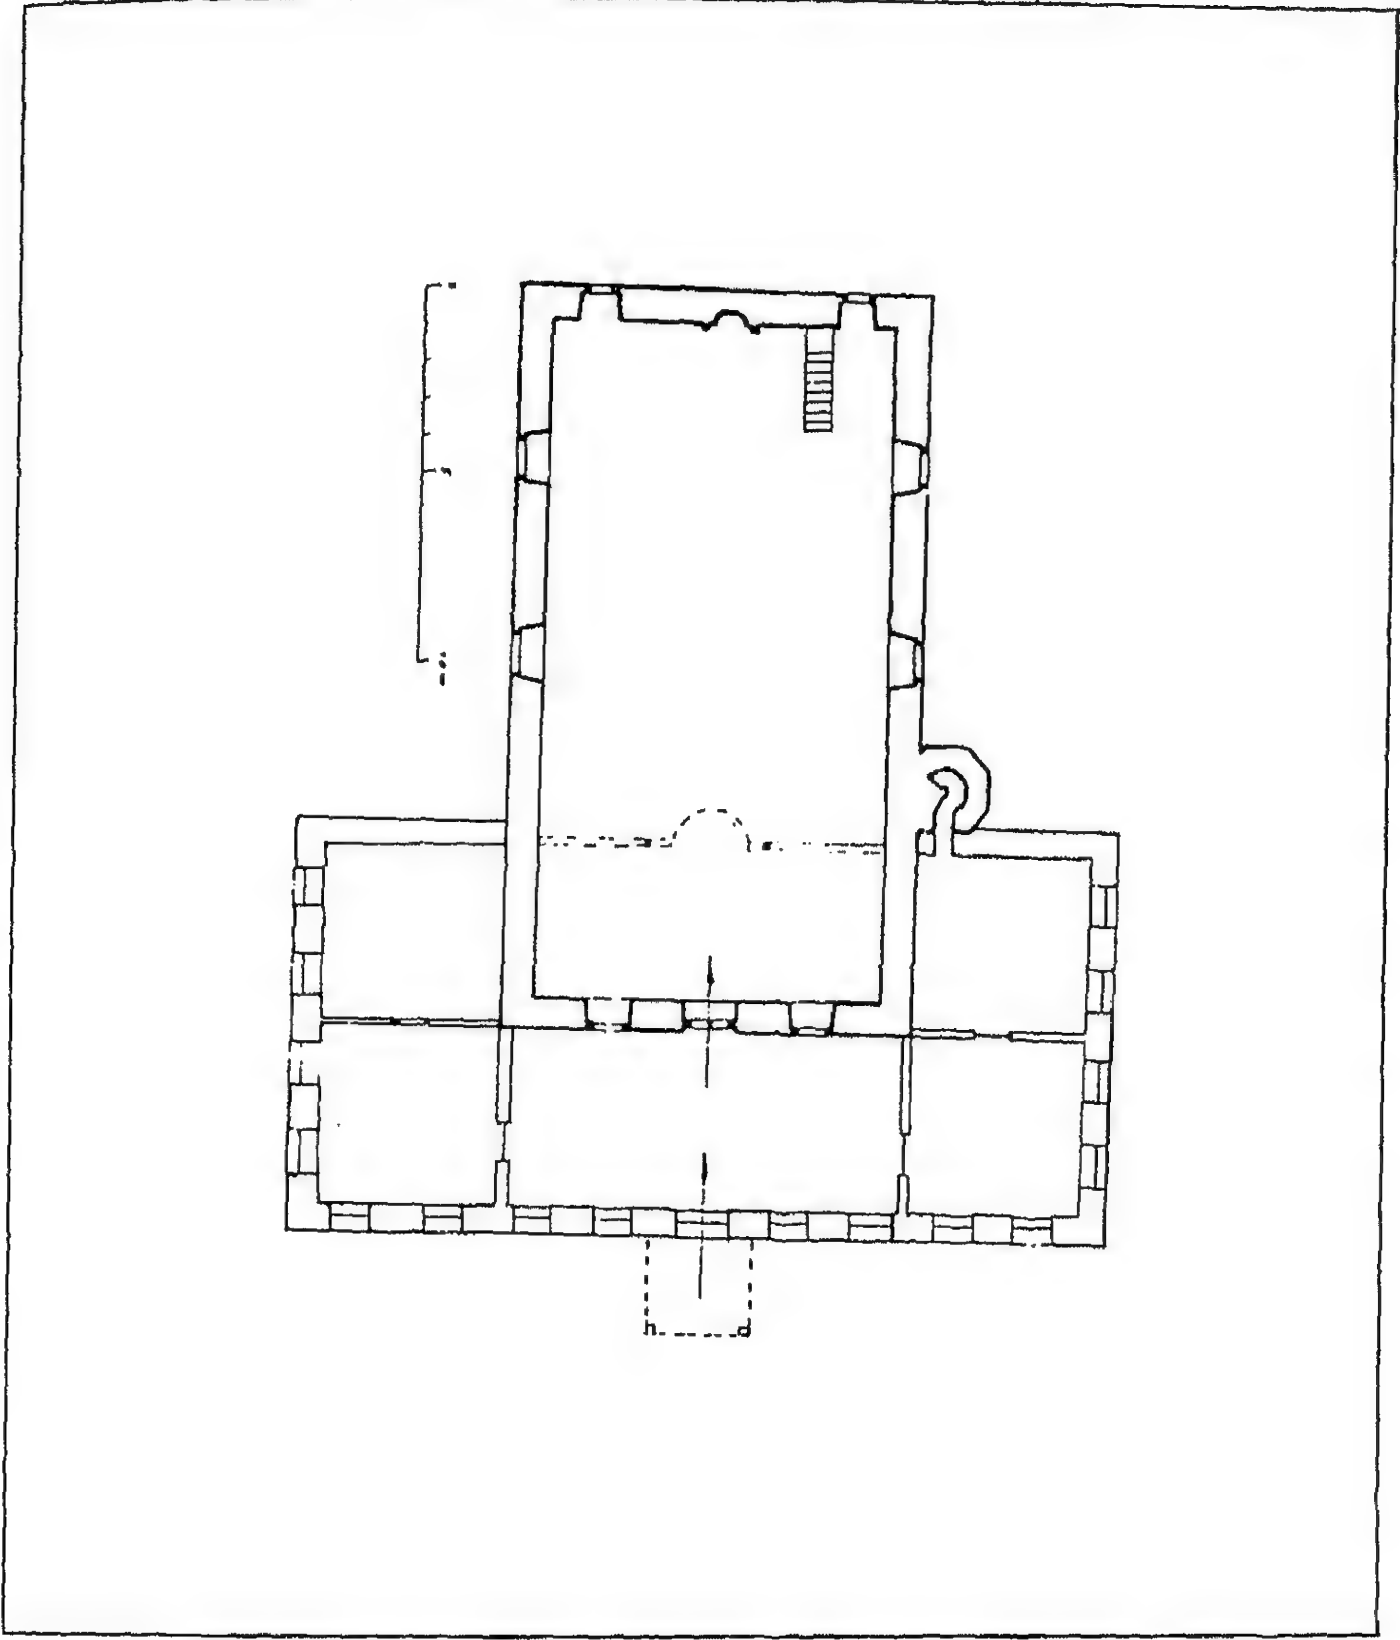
مسقط أفقي لمسجد حسام الدين في اشتب (عن : كيل) .
